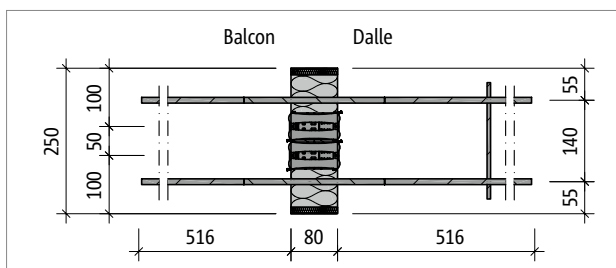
Schöck Isokorb® T Type Q-E-V5-L250 : Plan de base du produit
